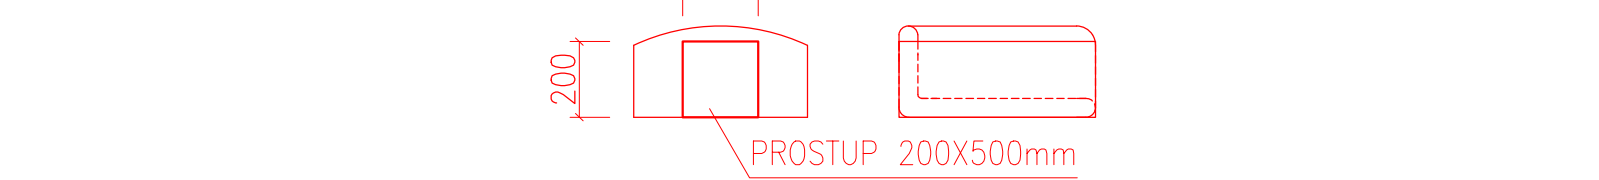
DETAIL KOTVENÍ TRAKČNÍHO VEDENÍ - PŮDORYS
